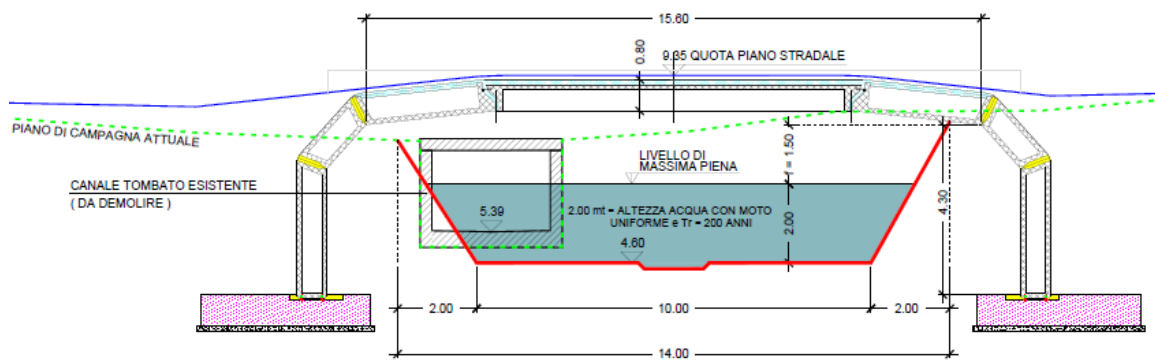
Sezione dell'attraversamento in corrispondenza della Sezione 30 di progetto.
